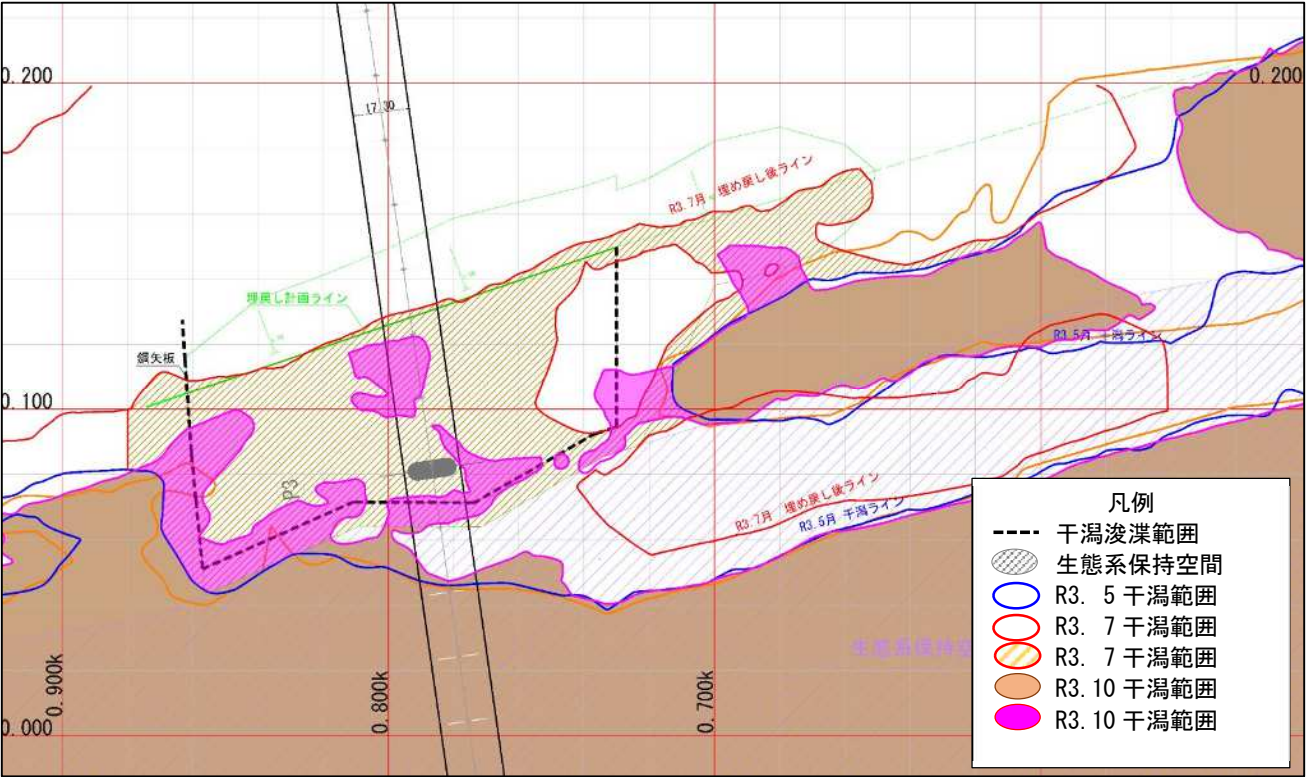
干潟地形測量結果平面図(令和 3(2021)年 10 月)
